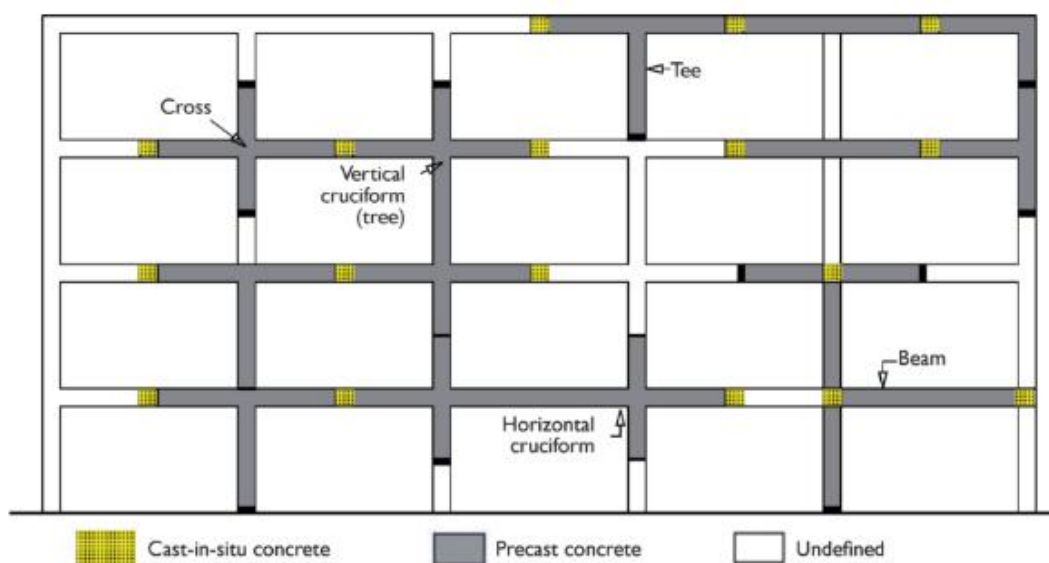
Configuraciones de pórticos con elementos prefabricados.
